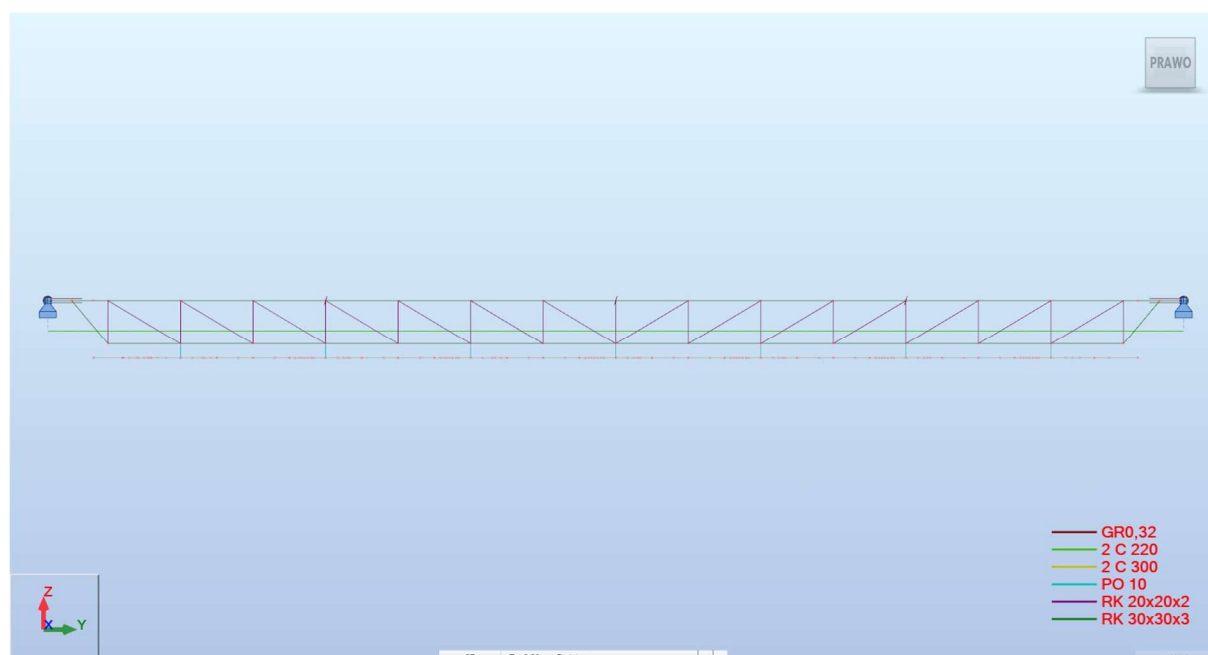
Konstrukcja wsporcza sufitu podwieszanego - model geometryczny 3D - widok 1
